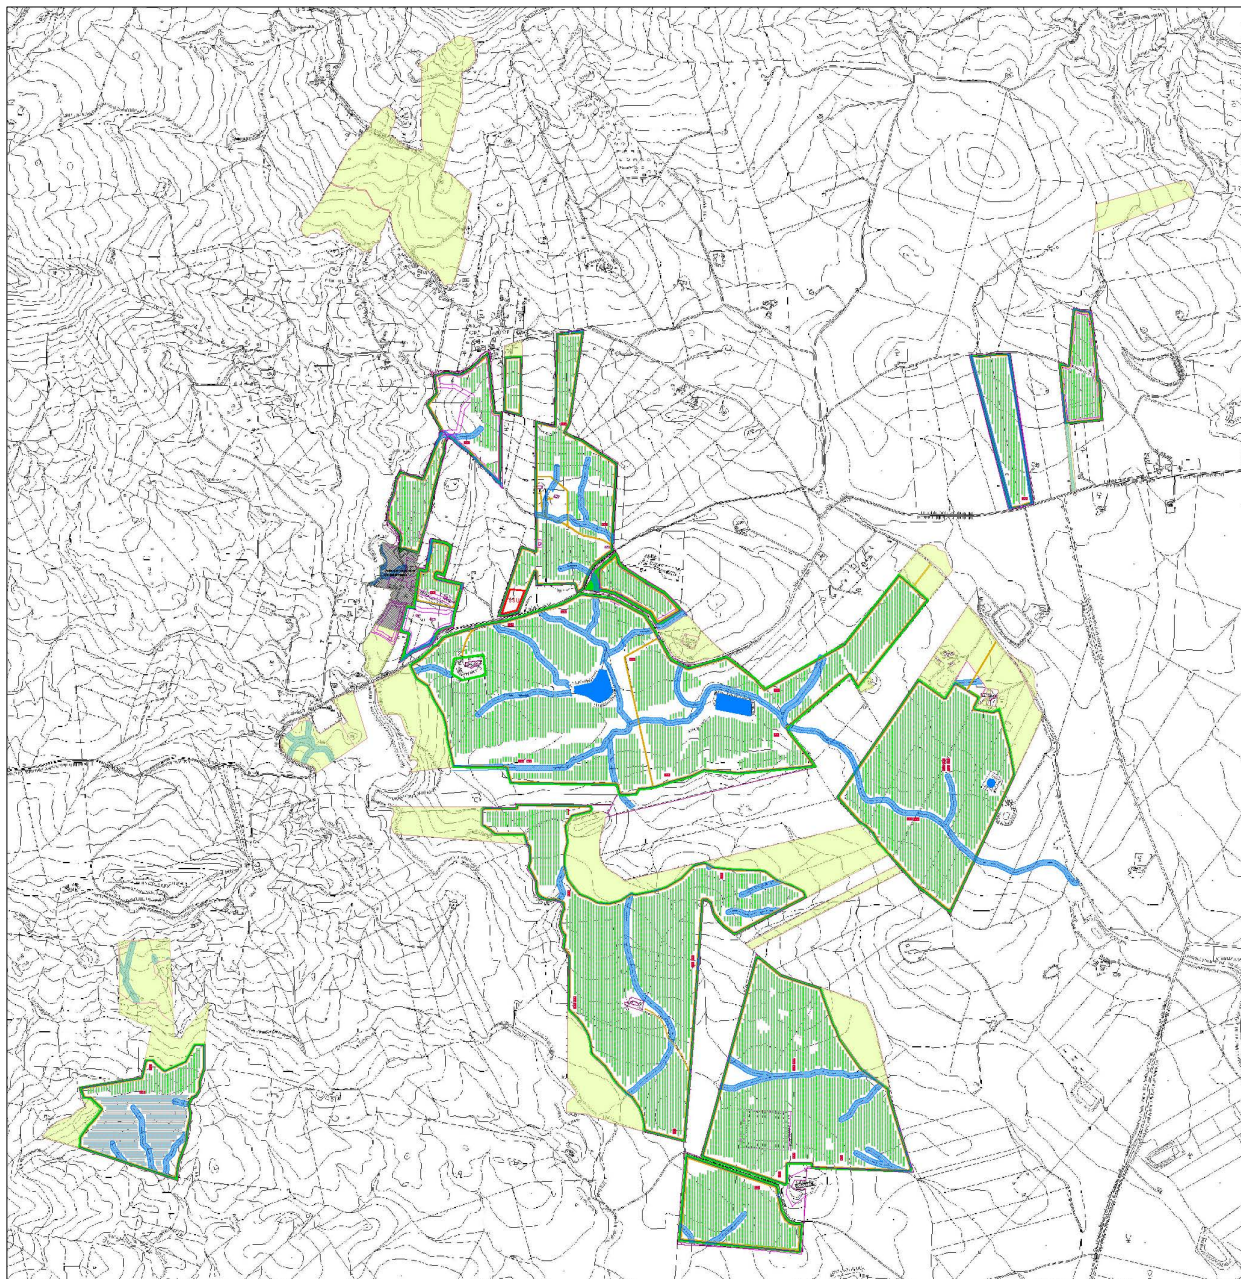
Layout dell'impianto su CTR scala 1:10.000
